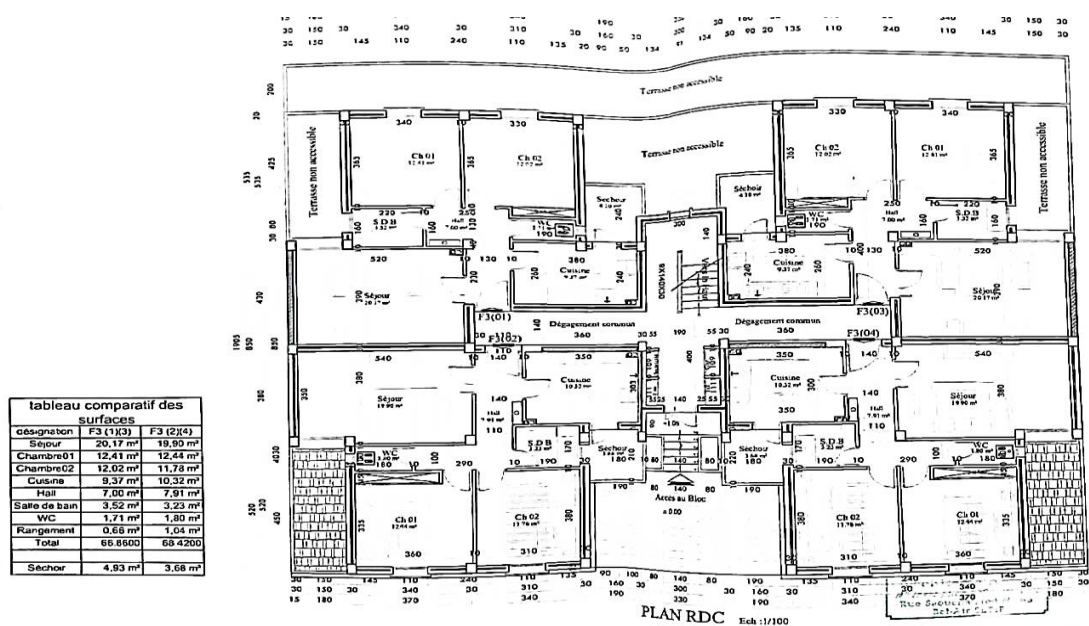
Plan du RDC jusqu'à 4ème étage de bloc A, B, C (Barre)
